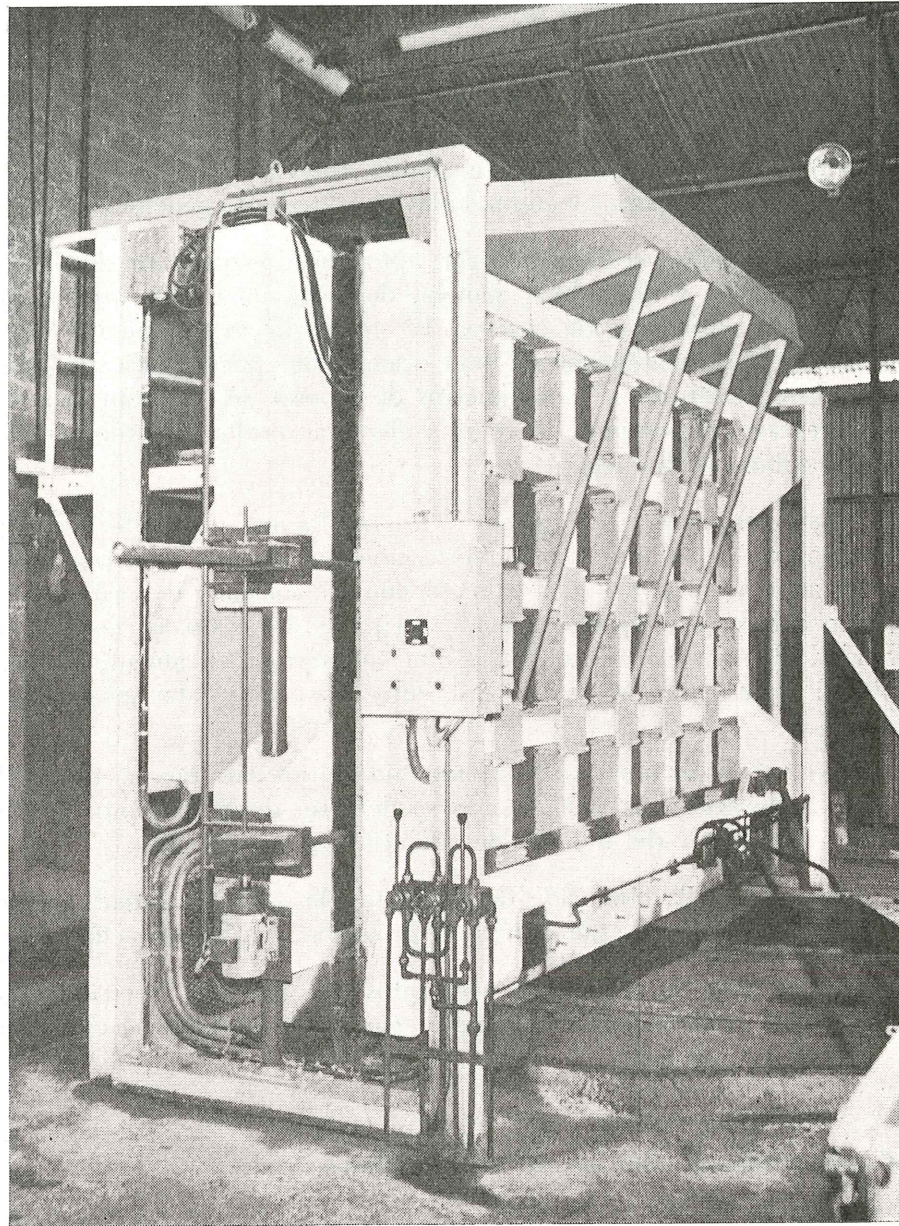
Prefabricación de paneles en Rouen - Sotteville. Para acelerar el fraguado y endurecimiento, se utiliza el método basado en la conductibilidad eléctrica del hormigón. Cada una de las dos caras verticales del molde, de separación variable, constituye un electrodo.
